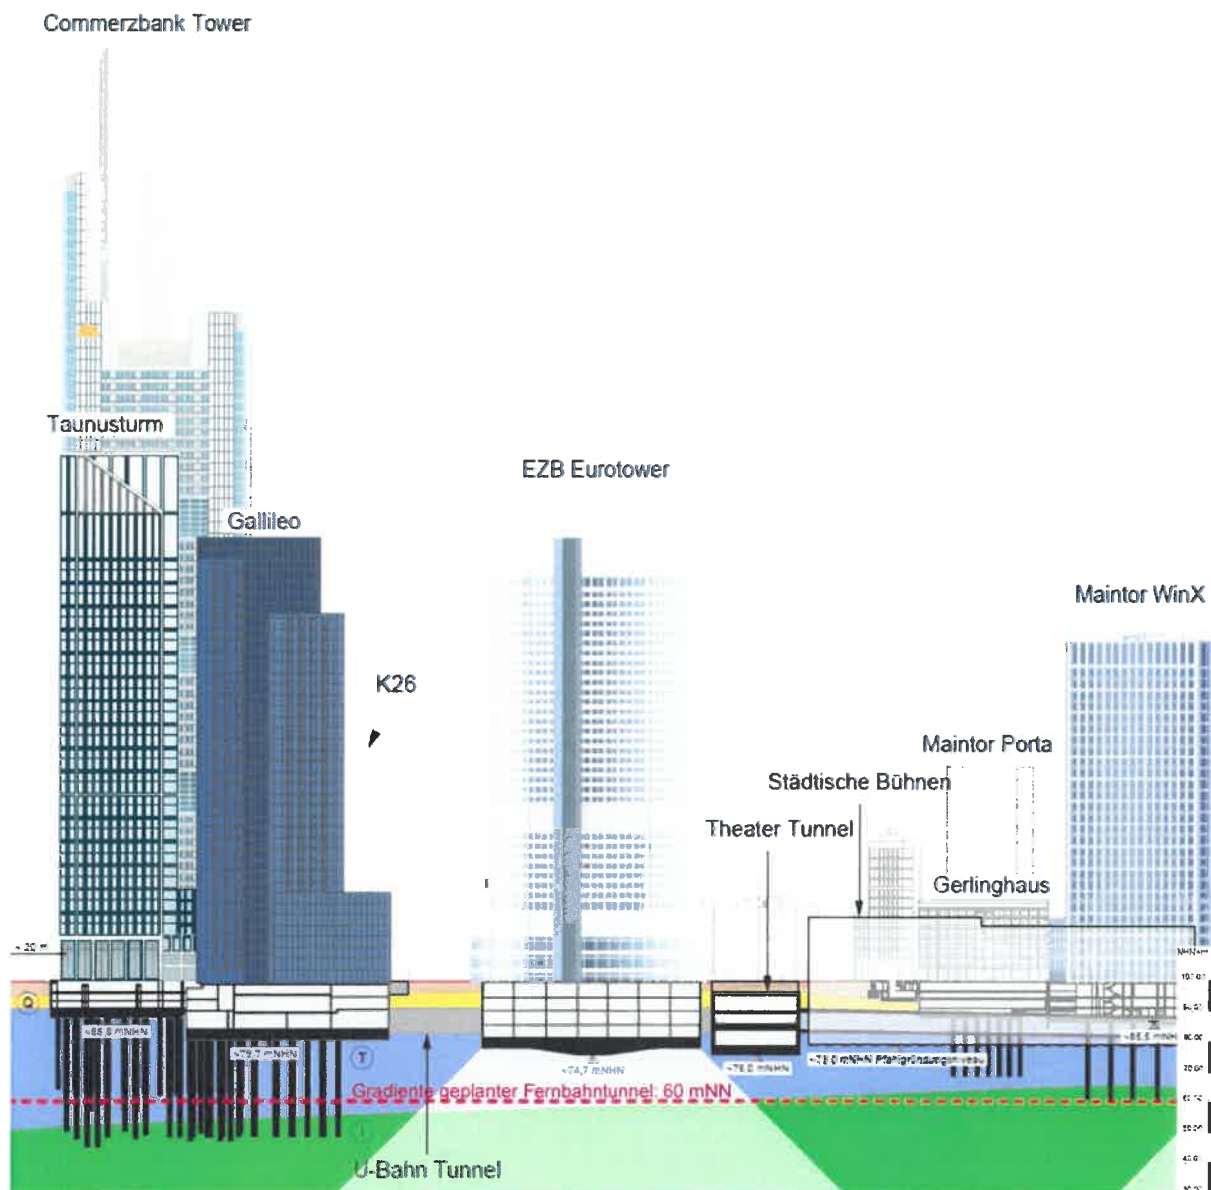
Auszug aus Plan „Baugrundschnitt (S I) durch die Wallanlagen (schematische Darstellung) inkl. Lastausbreitung der bestehenden Flachgründung“
